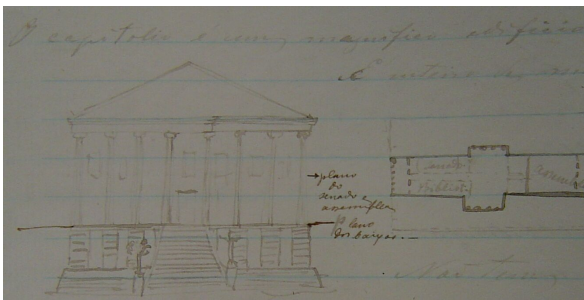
Elevação e planta do Capitólio em Nashville, Tennessee.
